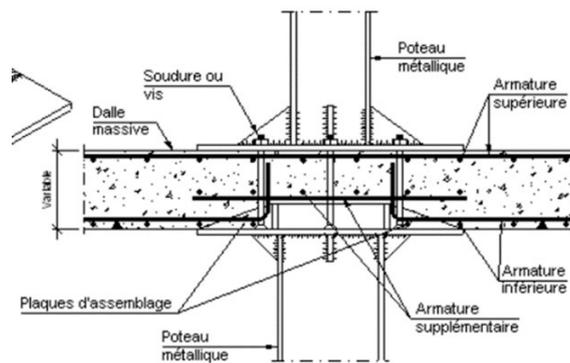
assemblage poteau mixte et dalle pleine⁶³
